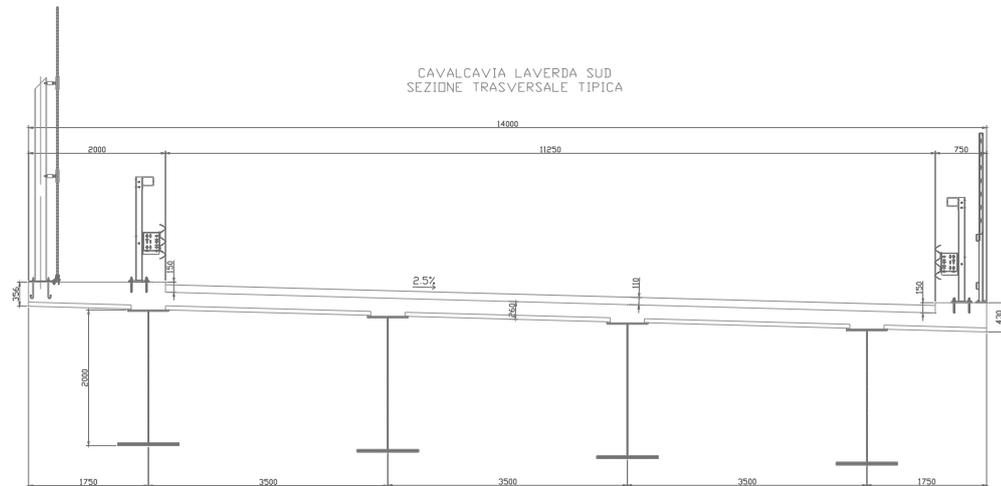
Sezione trasversale Ponte Torrente Laverda asse Sud
